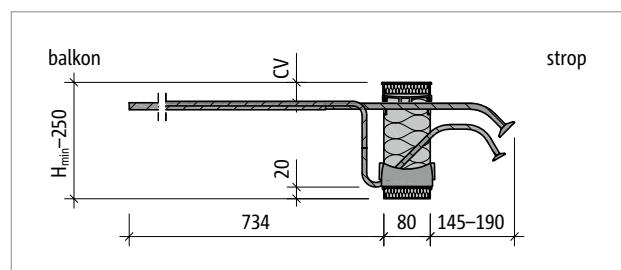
Schöck Isokorb® T tip KL-U-M4: tloris proizvoda
